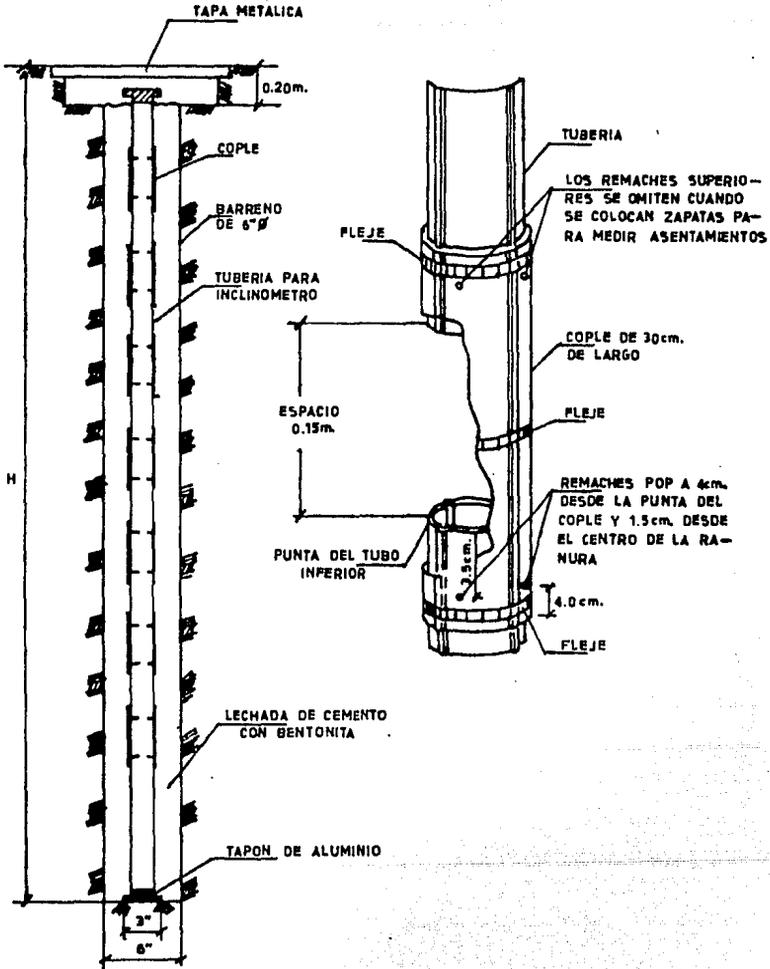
Instalación y detalle de la tubería para inclinómetro
